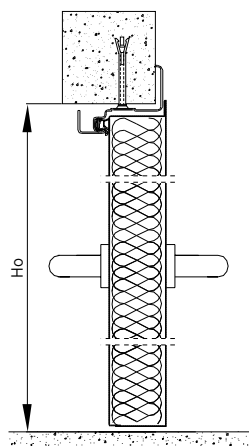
Pose entre murs d'un bloc-porte à un battant avec bâti angulaire - coupe verticale
